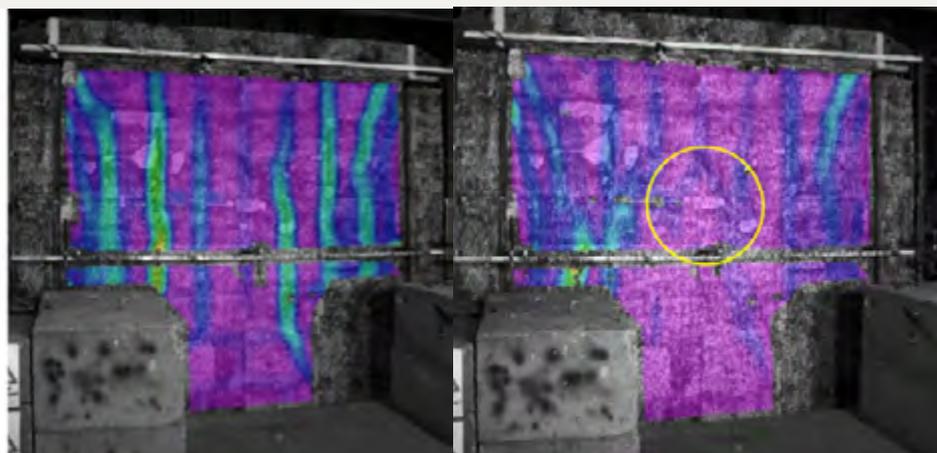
Fissures pendant l'essai (60 min) et au moment de la rupture (fissures diagonales entourées en jaune) - photos CSTB
